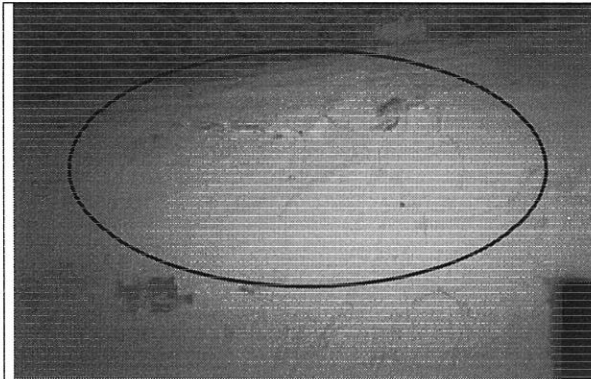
Agrietamientos en la zona superior de los muros de la habitación frontal
